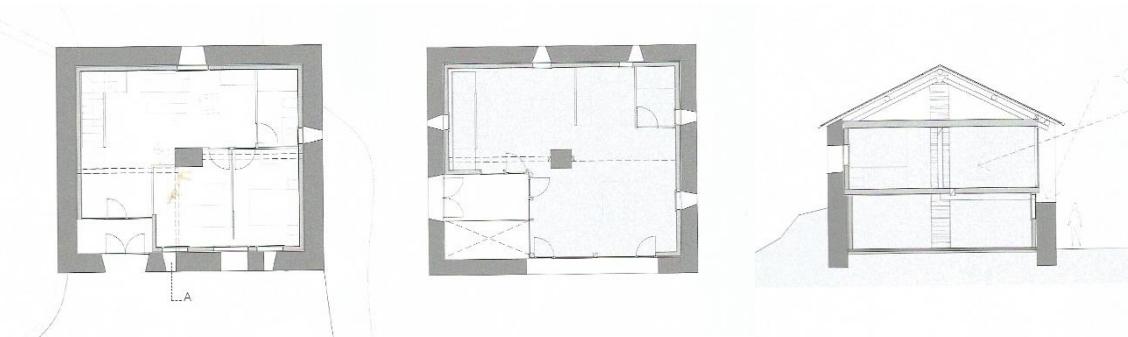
Plantas y sección [Libro Josep Bunyesc. Arquitectura Positiva]
